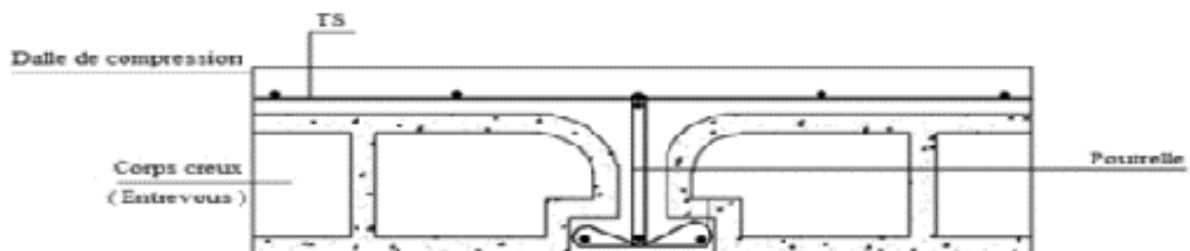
Coupe transversale d'un plancher à corps creux.
